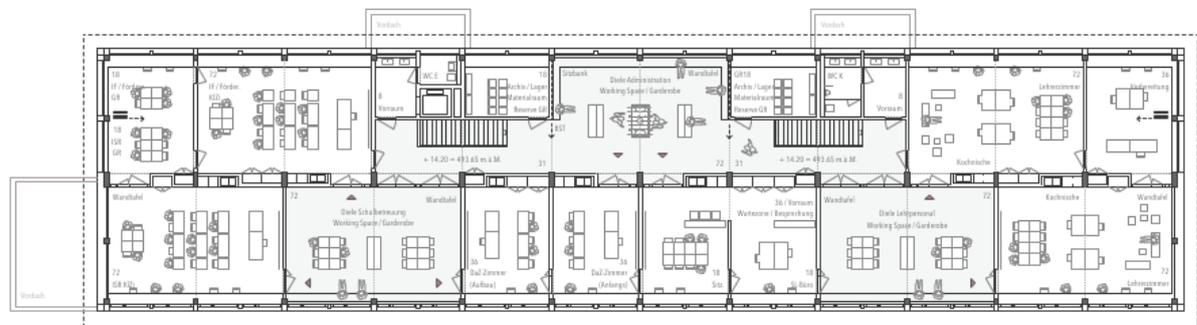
Neubau Primarschule, Grundriss 4. Obergeschoss
